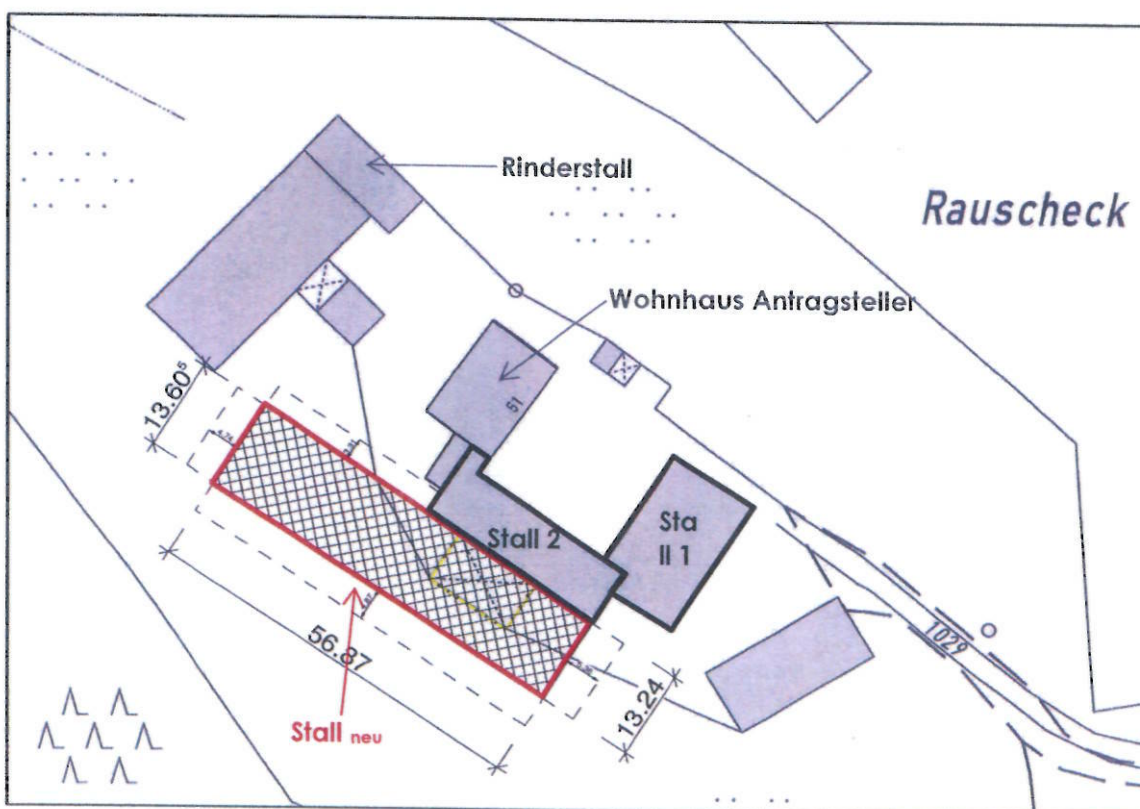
Lageplan mit Darstellung des beantragten Schweinehaltungsbetriebes
